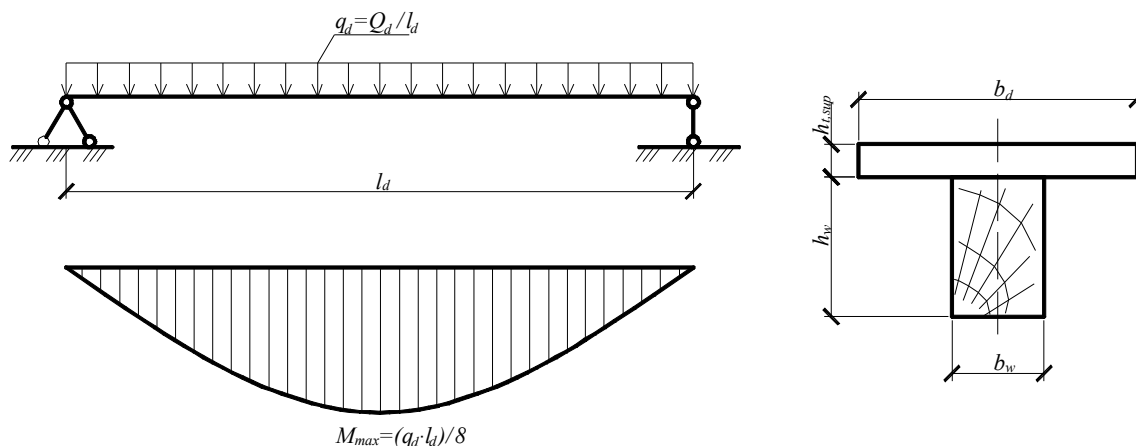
Расчетная схема плиты, расчетное поперечное сечение
